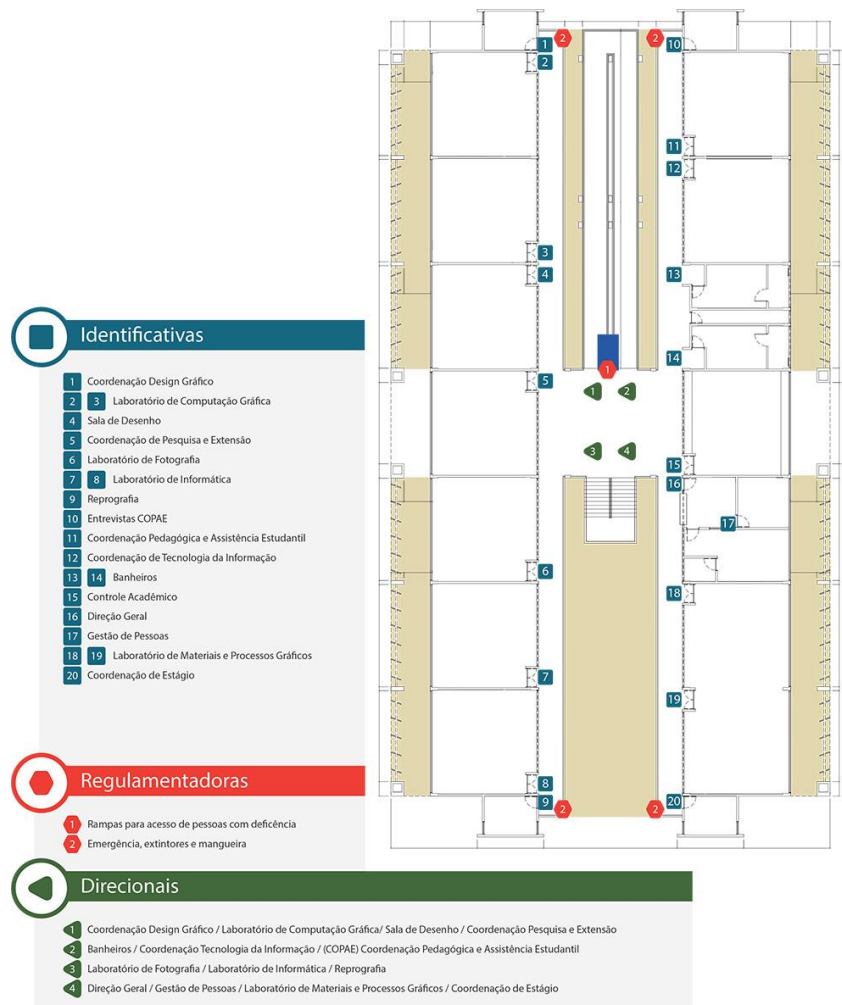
Marcação dos tipos de sinalização: 1º pavimento, idêntico ao 2º pavimento.
